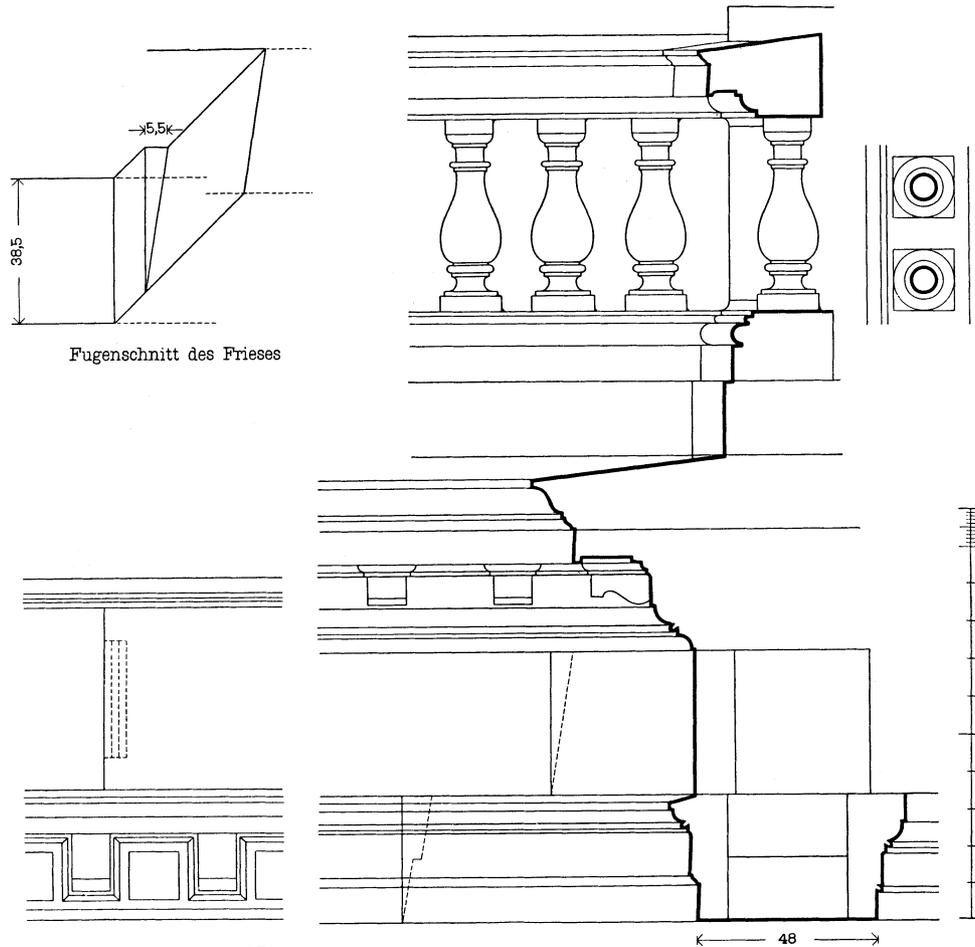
Gebälk und Dachbrüstung der Königs-Kolonnaden in Berlin. 1:20.
